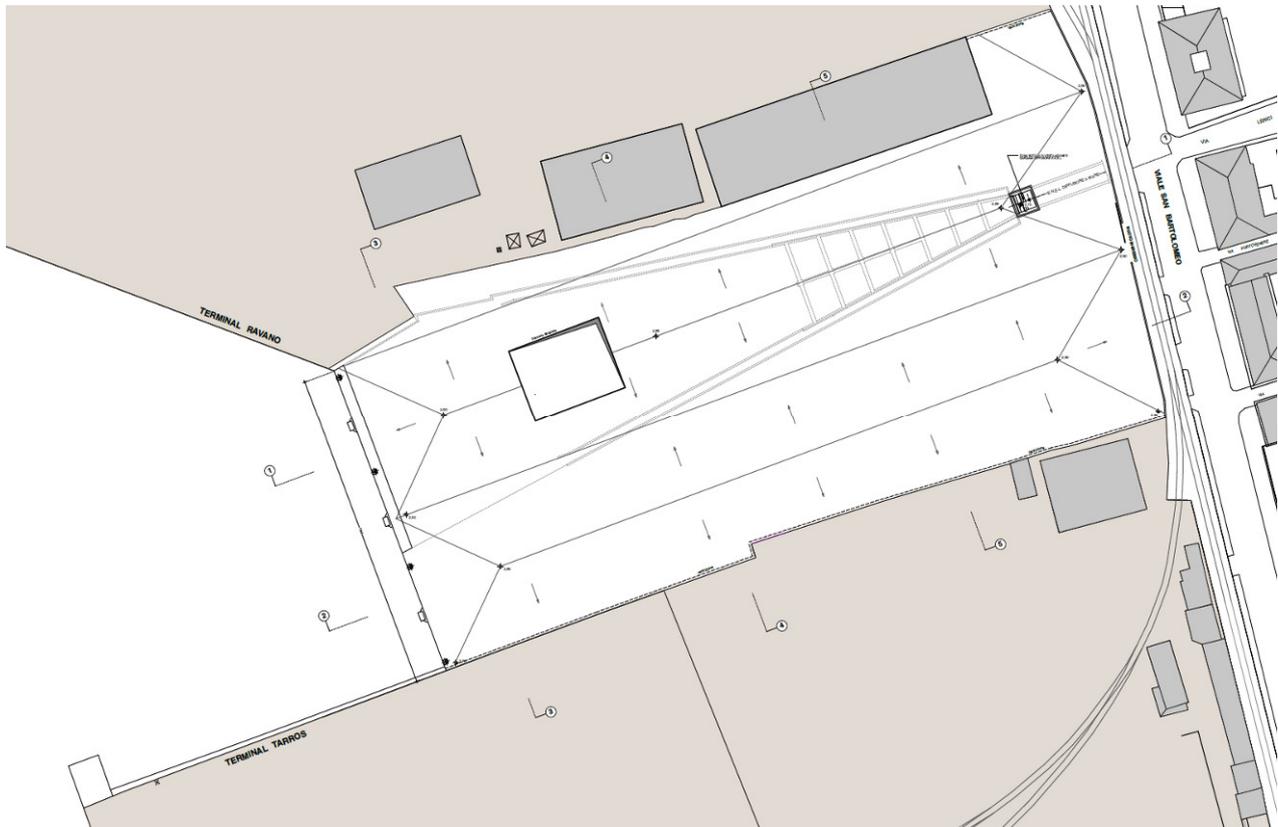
Ampliamento Fossamastra: planimetria di progetto di sistemazione finale del piazzale
